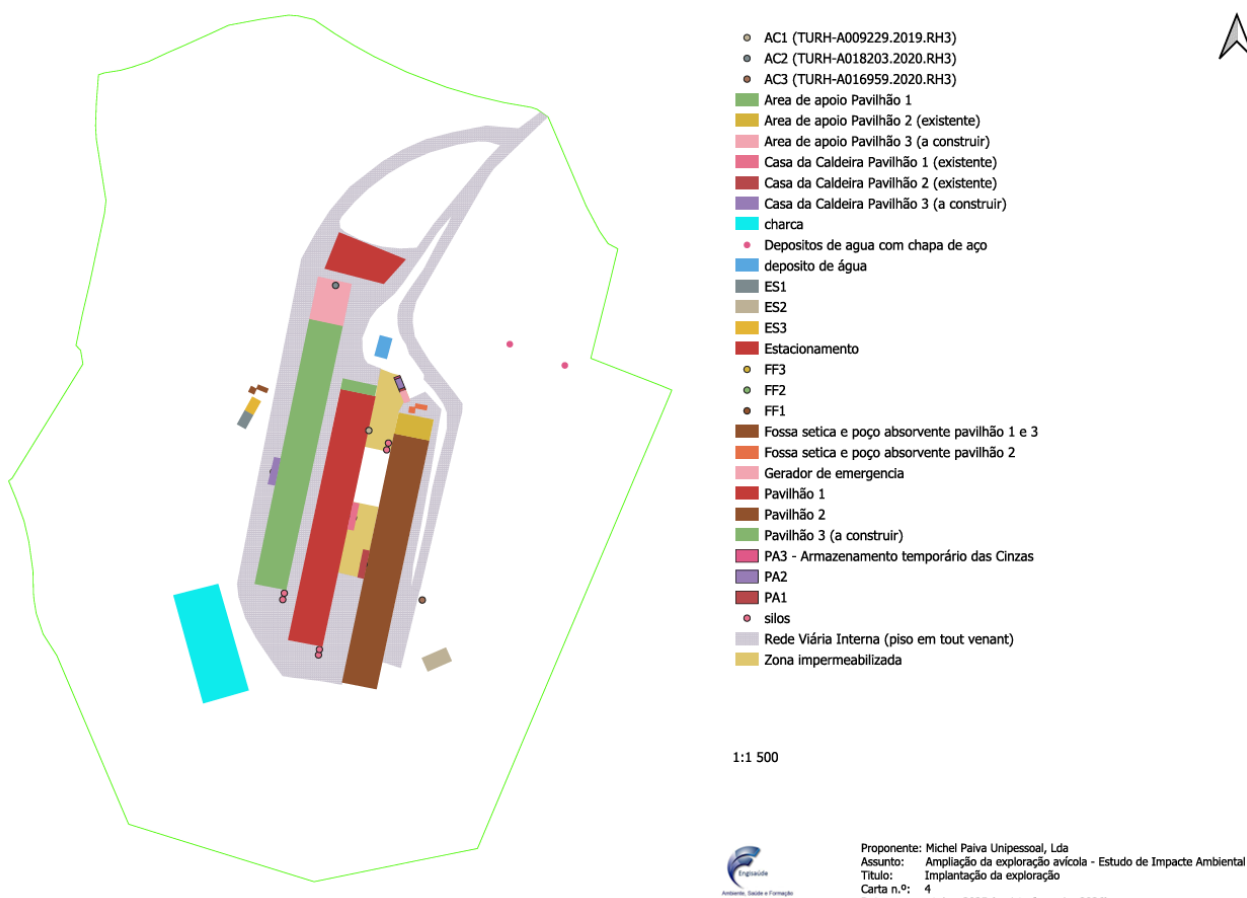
Planta de implantação da exploração. Fonte: Relatório Síntese (RS)
